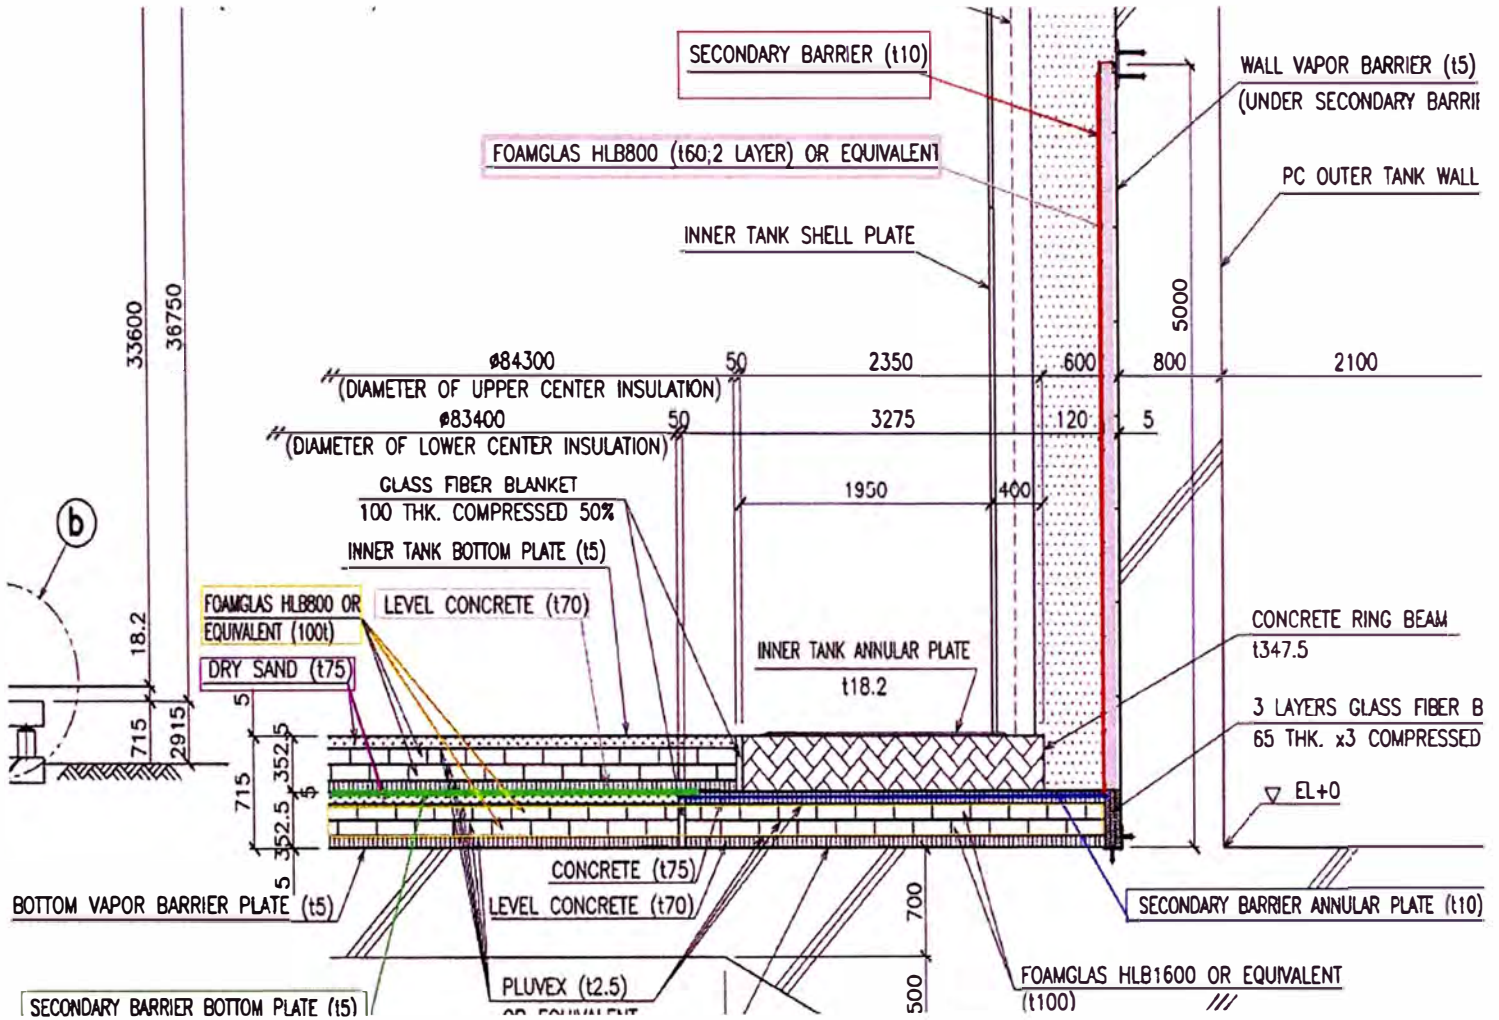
DETALLE B ESQUINA DE PROTECCION
